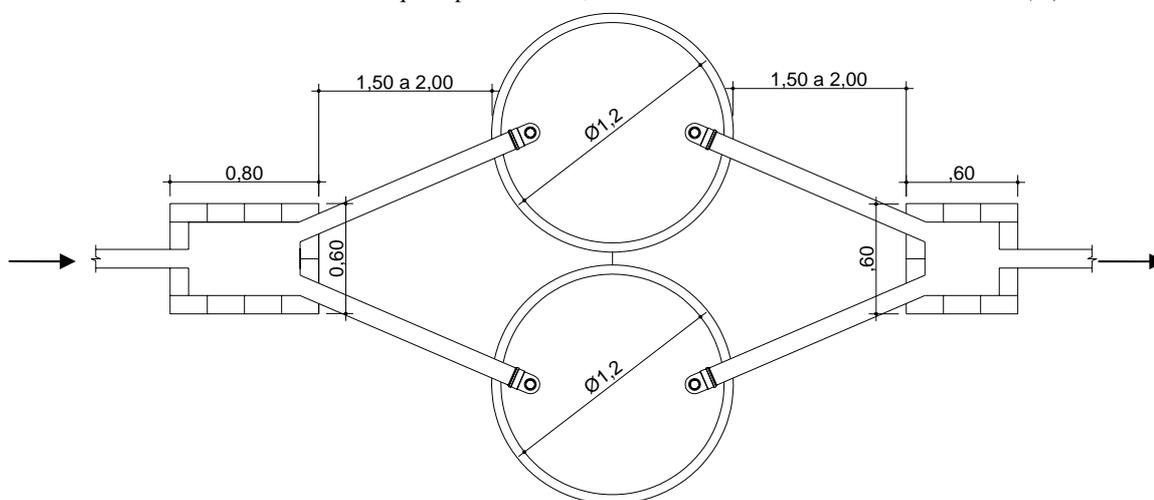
Detalhe do sistema de ligação entre as duas fossas, com caixa de passagem. *Dimensões em metros (m).
